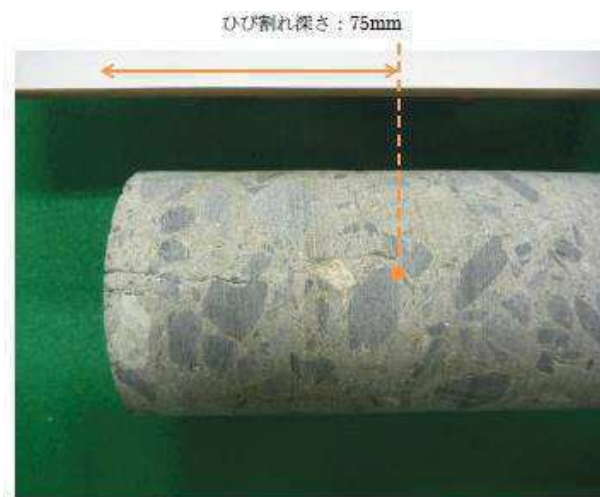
ひび割れ箇所から採取したコンクリートコアの例（採取位置：④）
